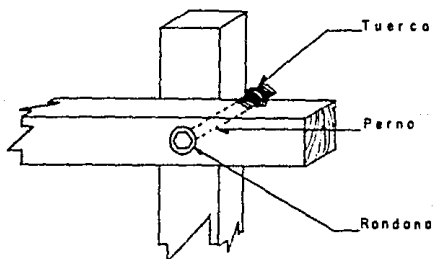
Uniones típicas de elementos de madera con perno.
